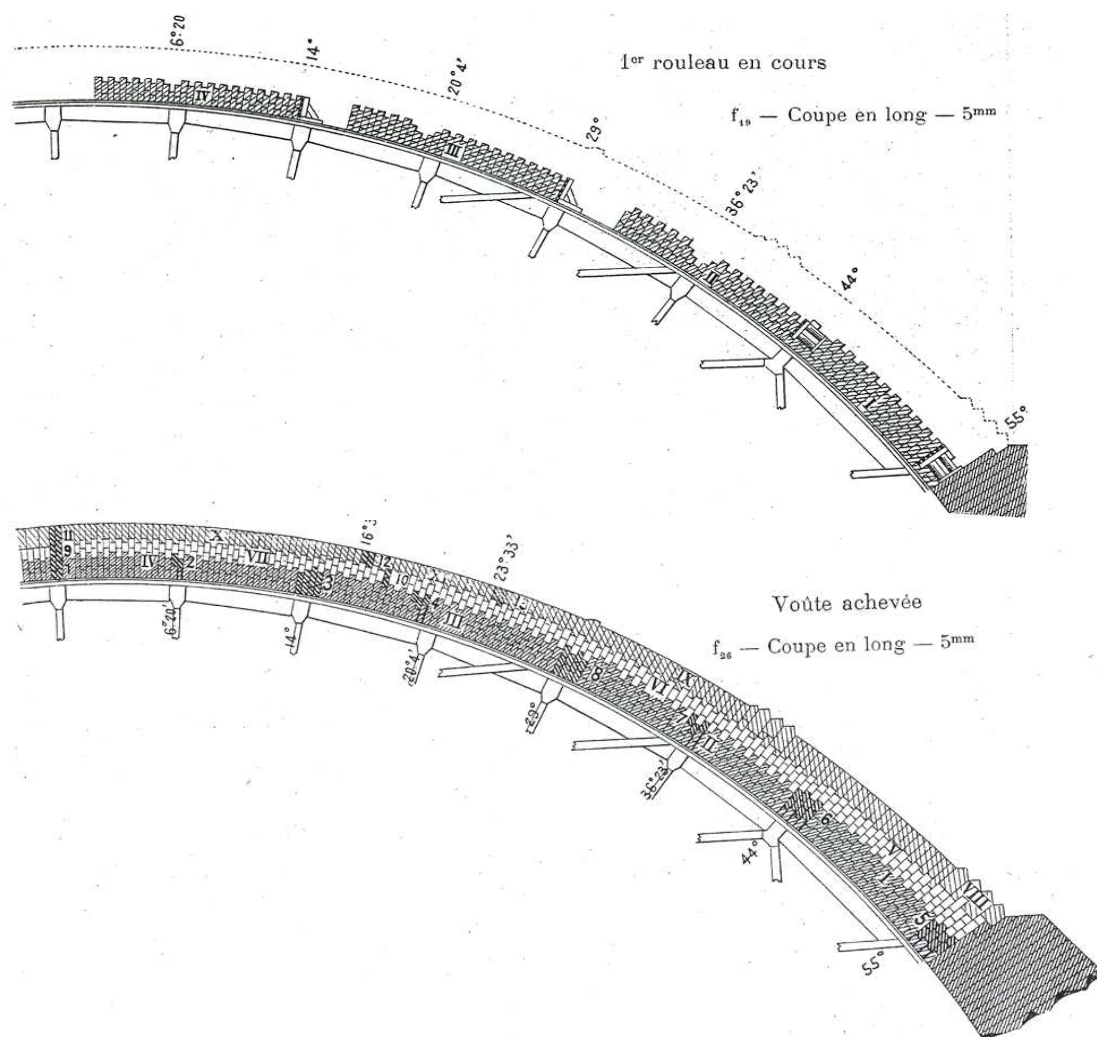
Pont de Lavaur, construction par rouleaux successifs, 1883 (Séjourné).
